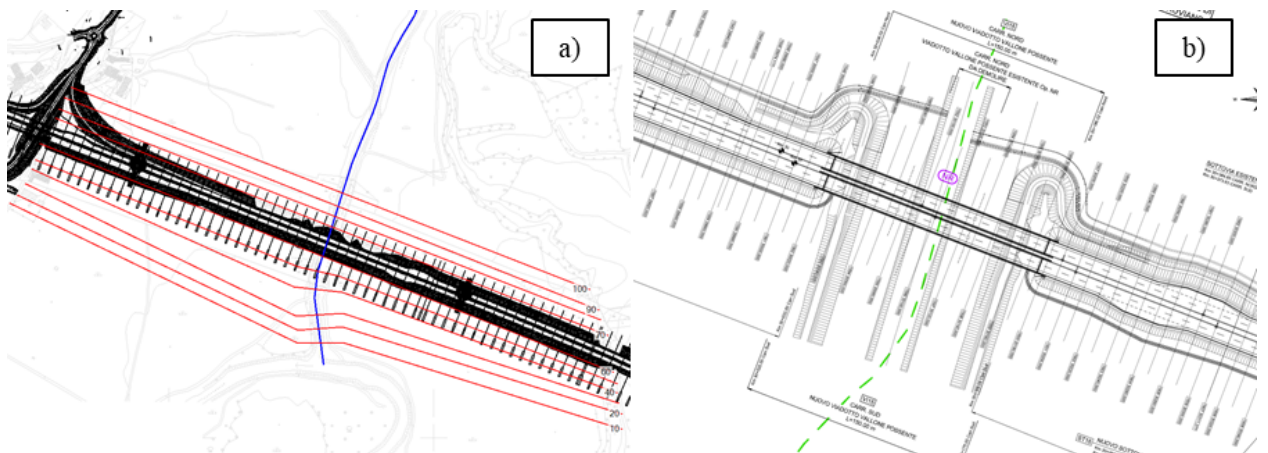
Inquadramento planimetrico della nuova opera VI15: a) sezioni modellate (planimetria modello idraulico), b) planimetria dell'inalveazione del vallone
